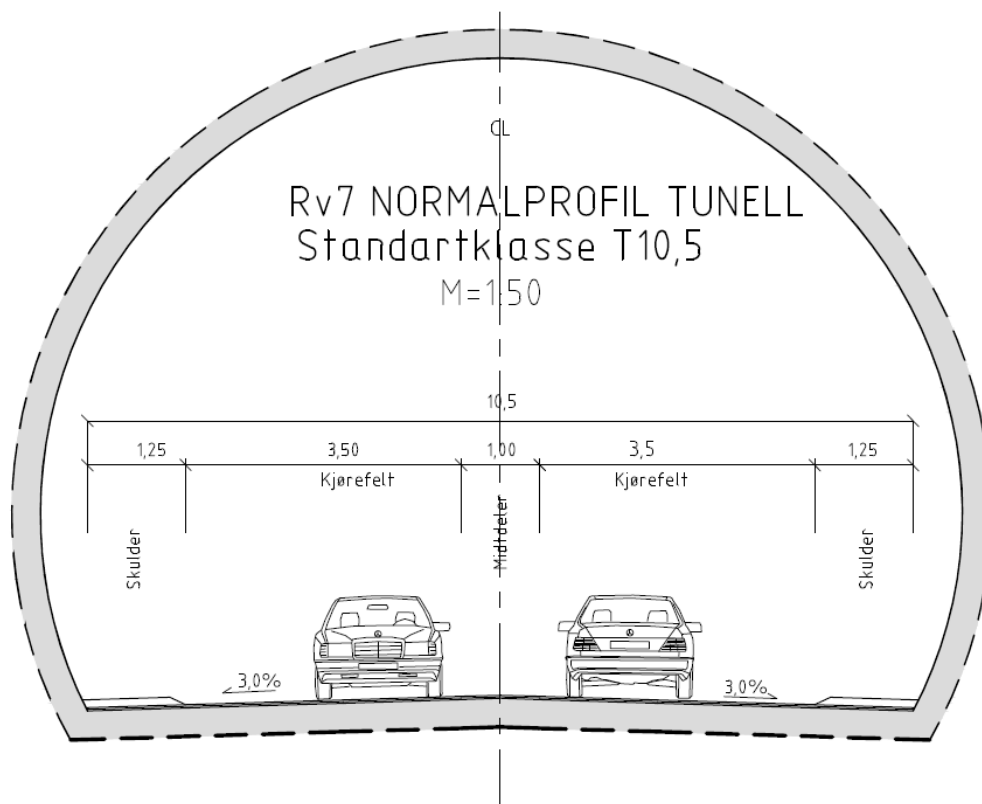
Tunnelprofil T10,5 (mål i m)
